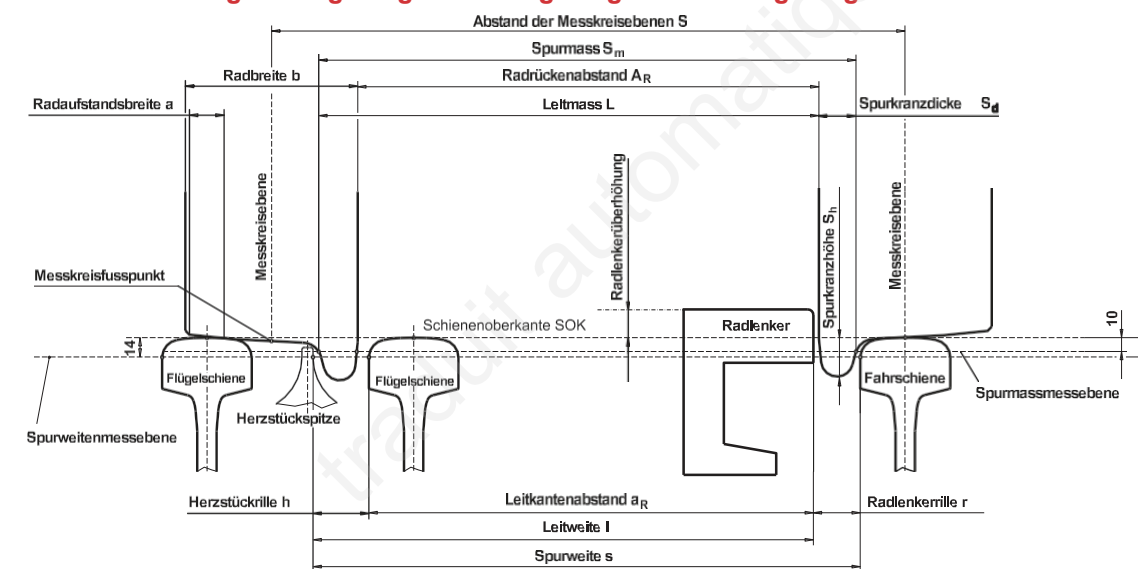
Coupe d'un essieu dans un aiguillage.
